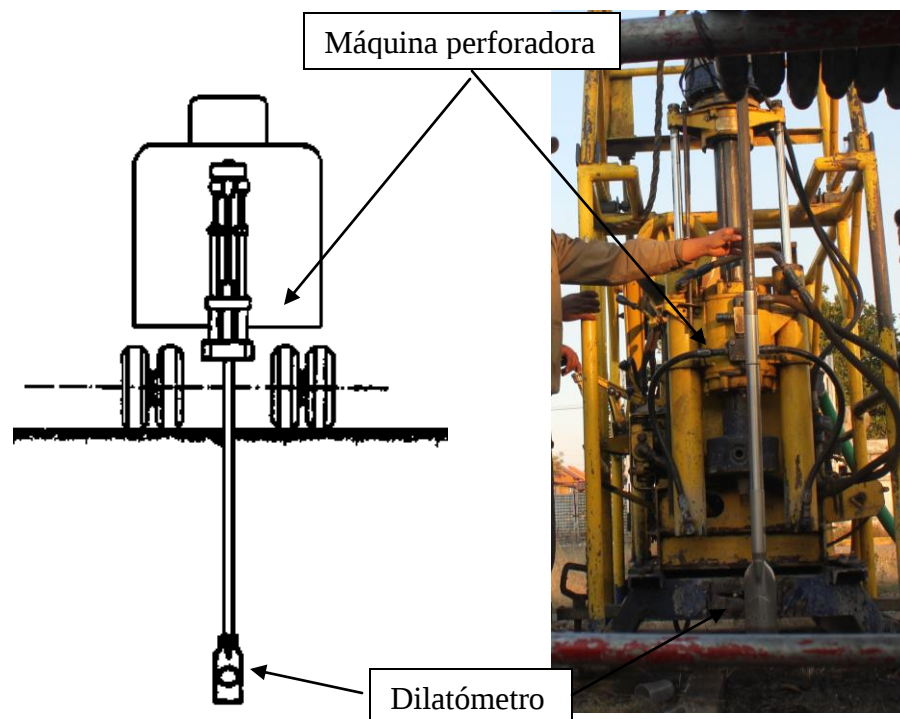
Vista esquemática del hincado del dilatómetro y equipo de perforación
